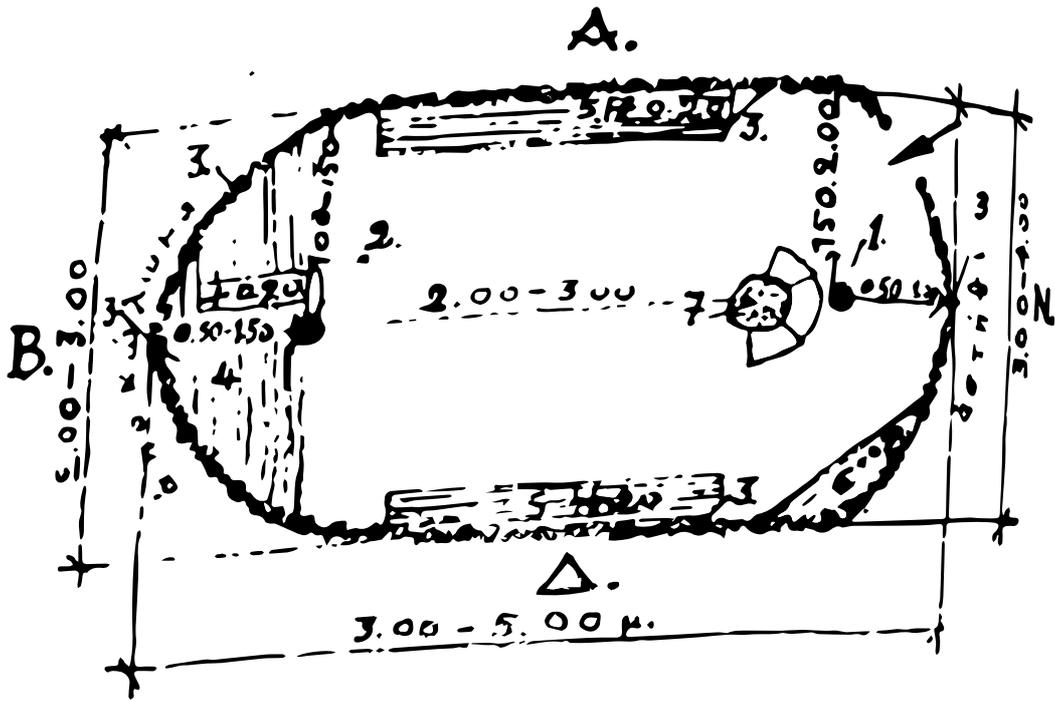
d: Grundriss der einzelnen (a)dipla- Hütte
